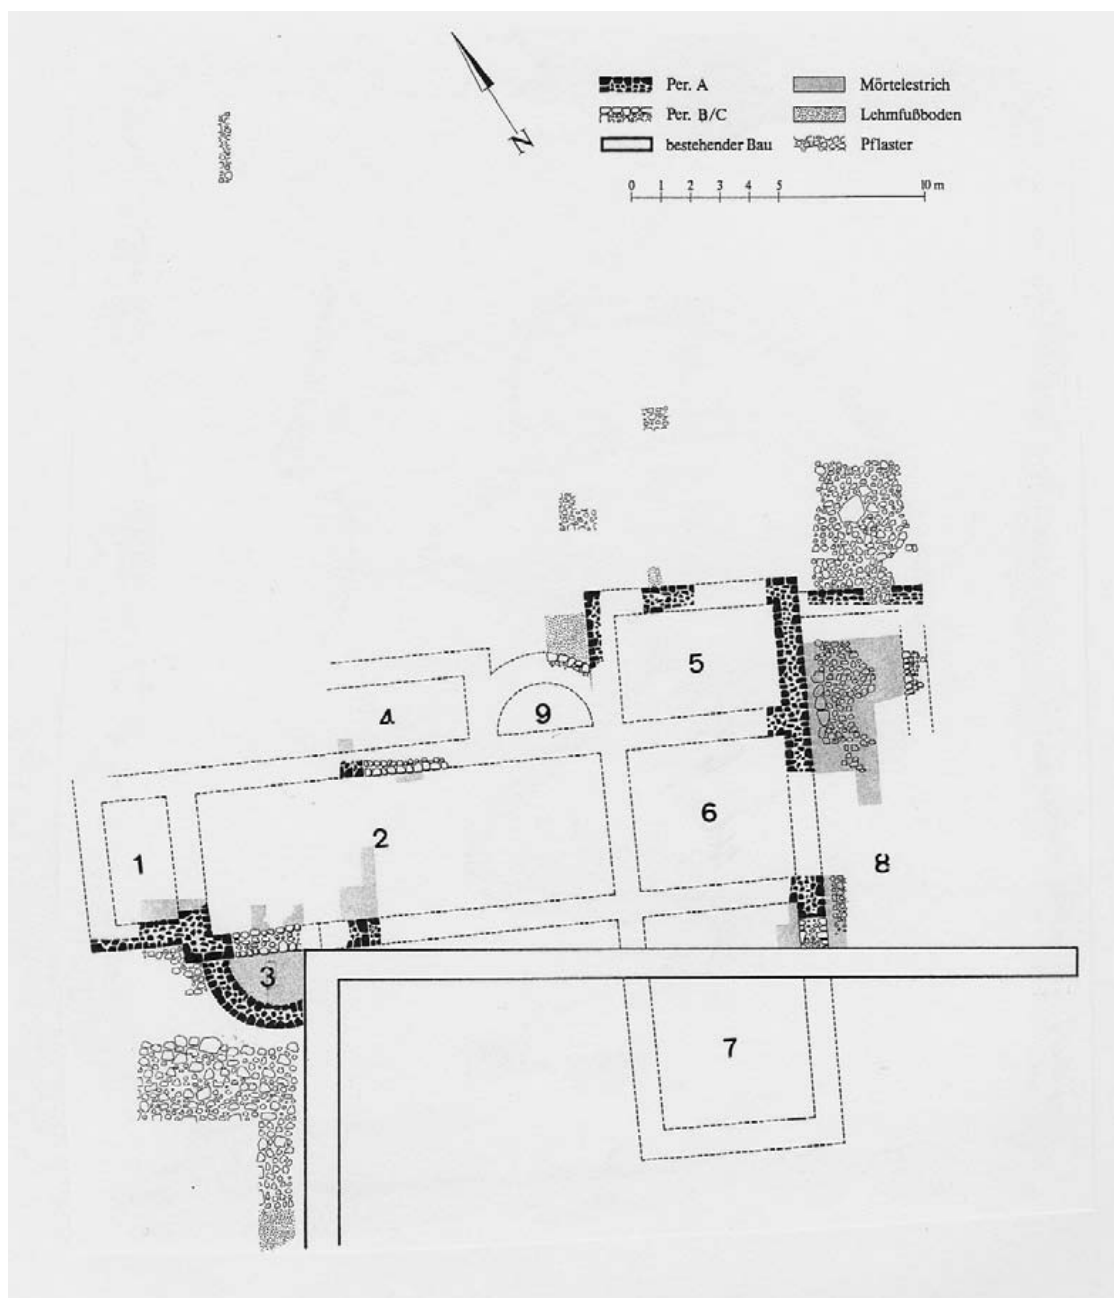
Steinheim. Römisches Bad. Plan der Mauer- und Fußbodenbefunde
